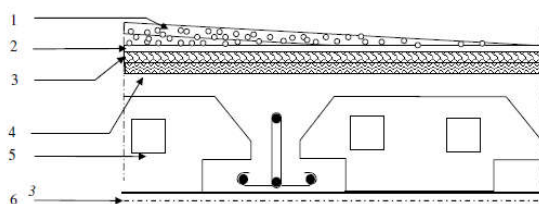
Composants d'un plancher terrasse accessible en corps creux.
